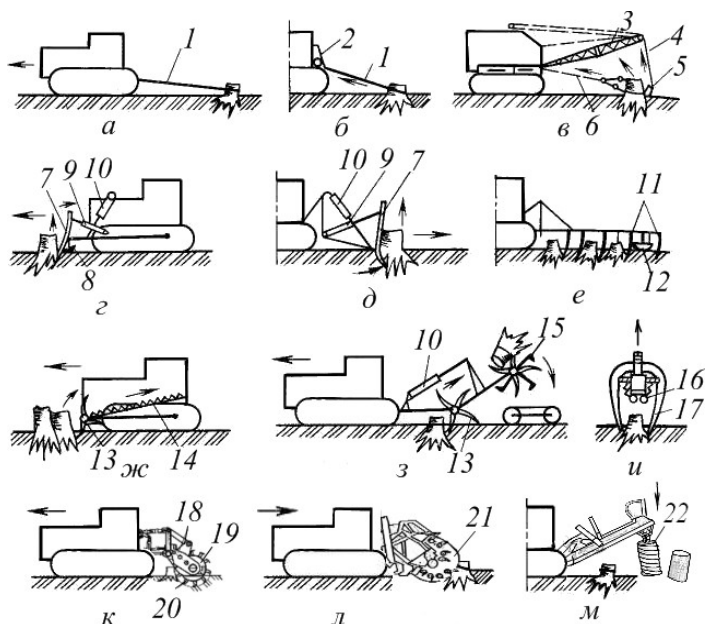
Корчевальные машины и орудия: а - корчевание прямой тягой; б - корчевание с помощью тракторной лебедки; в - экскаватор с корчевальным захватом; г, д - корчеватель с передней и задней навеской поворотного рабочего органа; е - корчевальная борона; ж, з - ротационный корчеватель; и - виброкорчеватель; к - роторный (барабанный) навесной измельчитель; л - дисковый навесной измельчитель; м - высверливание: 1 - канат; 2 - корчевальная лебедка; 3 - стрела; 4 - подъемный канат; 5 - корчевальные клещи; 6 - тяговый канат; 7 - щит-отвал зубьями; 8 - упорная лыжа; 9 и 10 - гидроцилиндры поворота и подъема; 11 - пассивный зуб; 12 - опорная скользящая лыжа; 13 - ротор; 14 - клавишный сепаратор; 15 - ротор-очиститель; 16 - вибратор; 17 - клещевой захват; 18 - редуктор; 19 - барабан; 20 - нож; 21 - диск; 22 - пустотелое сверло.
